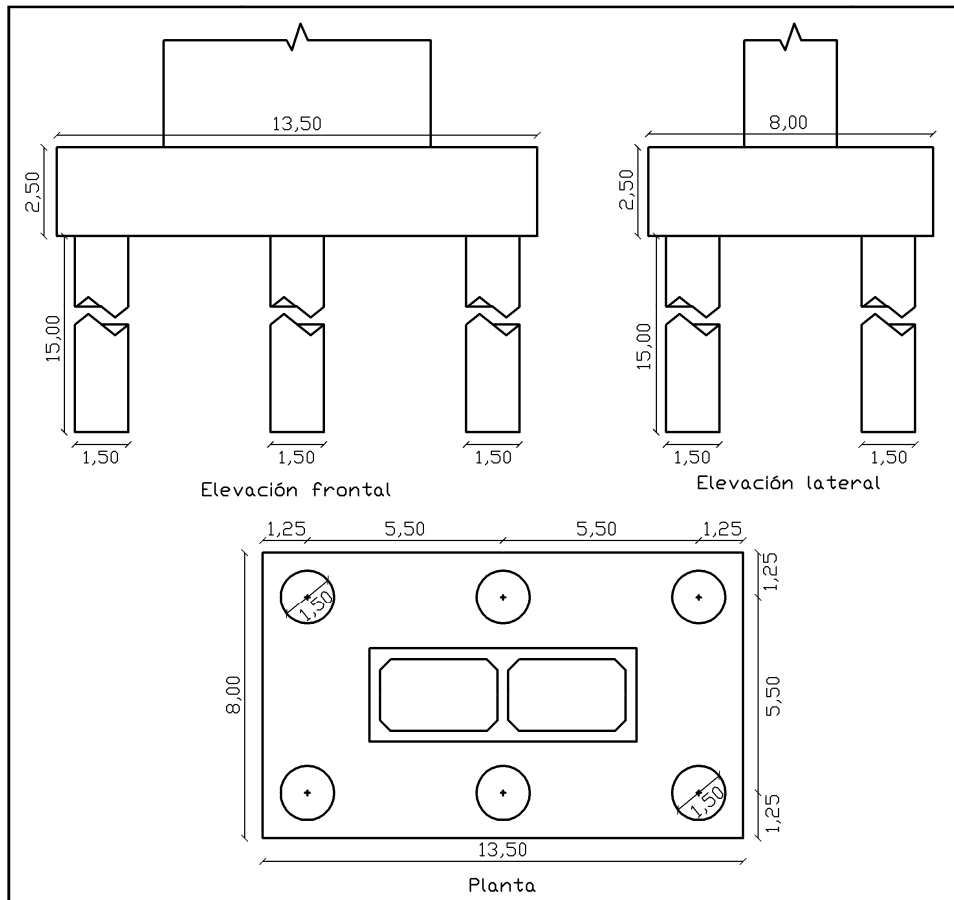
fundaciones profundas para cepas (dimensiones en m)
